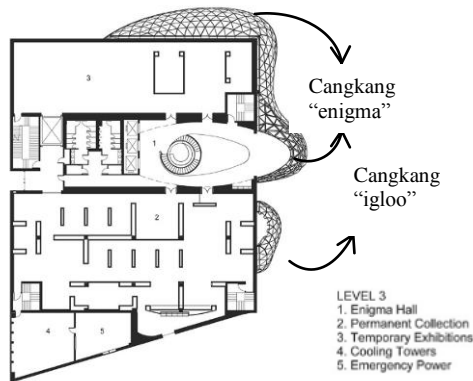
Denah Lantai 1 Salvador Dali Museum
